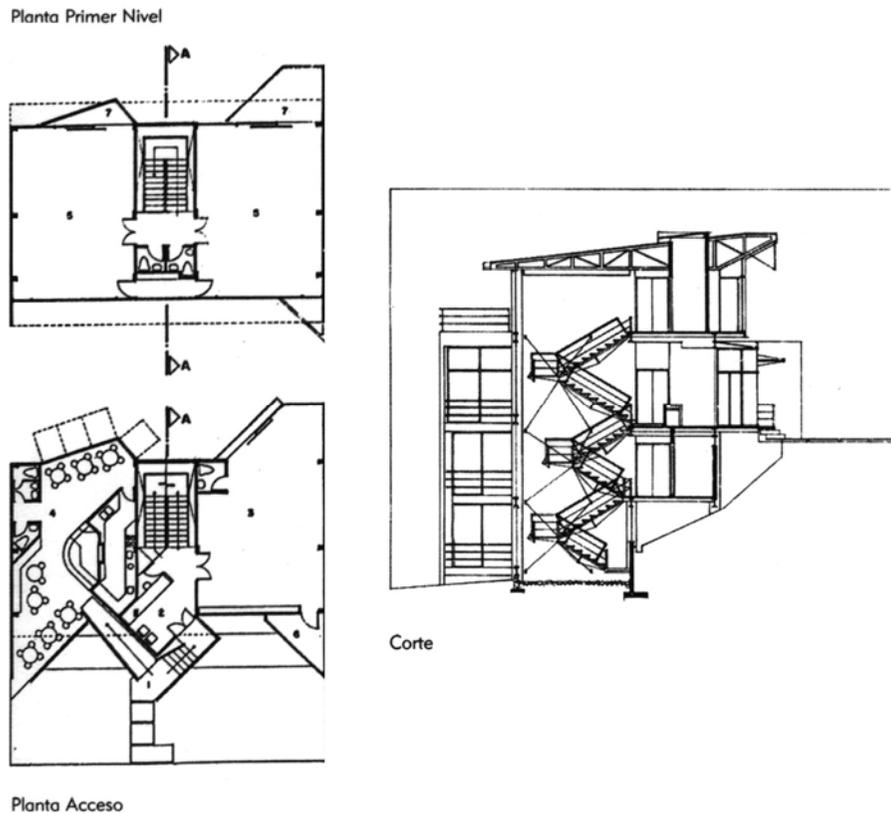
Planta de acceso, planta del primer nivel y corte del Centro Creativo.
